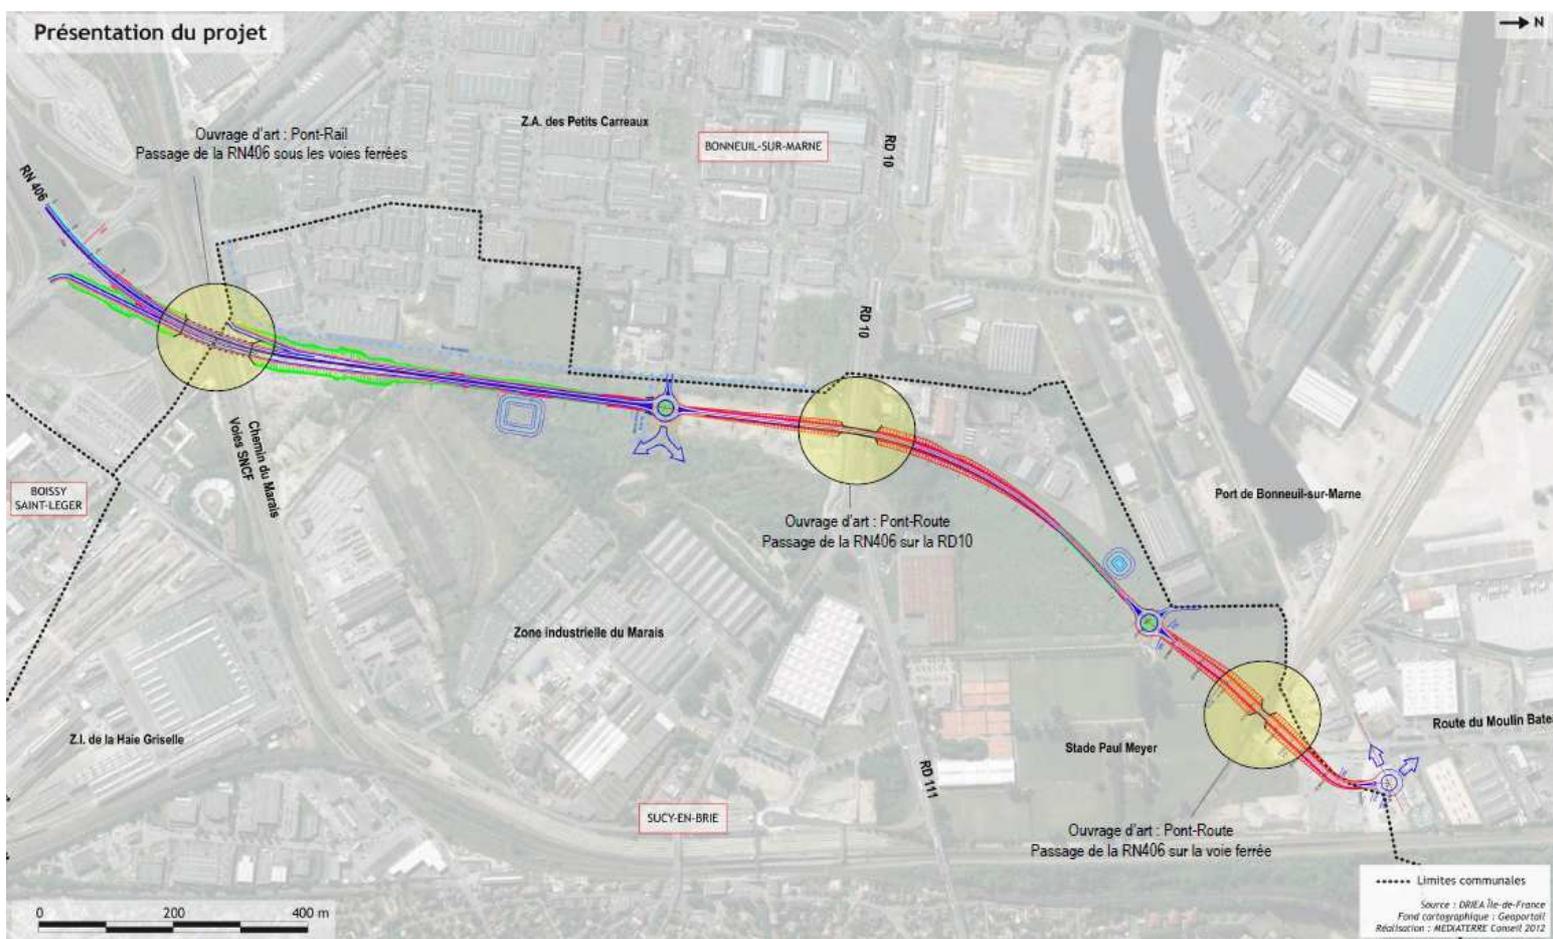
Plan général des travaux (page 48 du dossier d'enquête publique)
